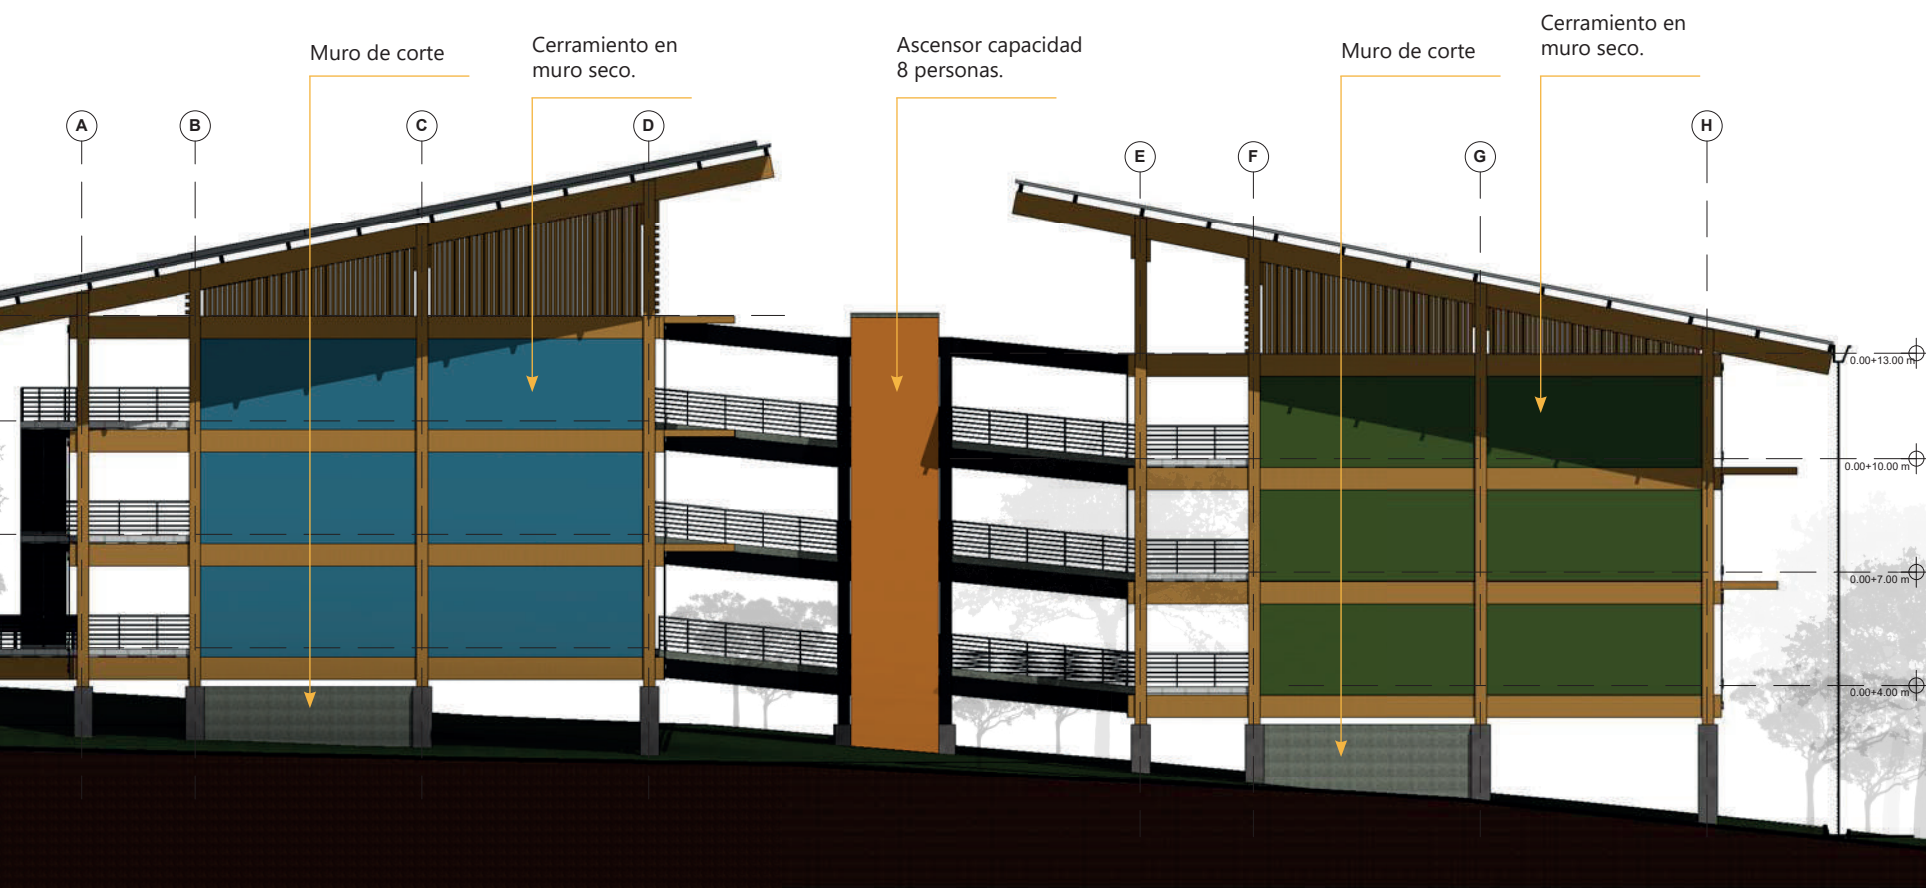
Vista externa fachada oeste bloque A y B. Fuente: Elaboración propia. (2017)
